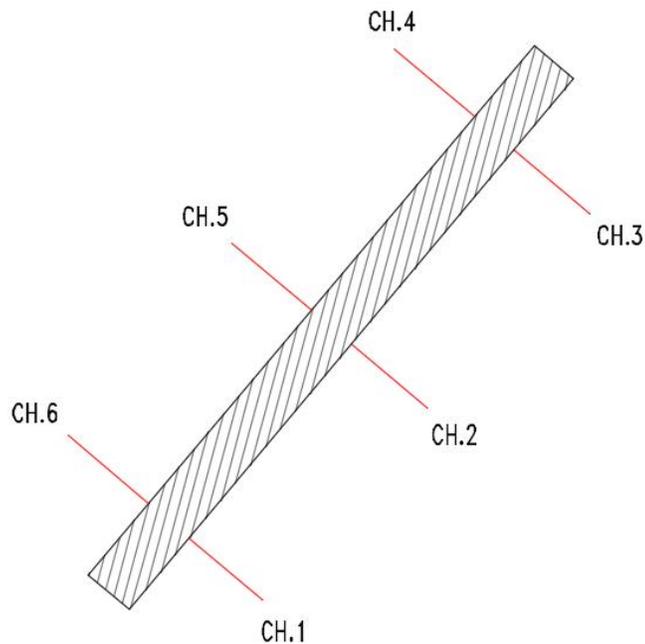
"Levantamiento en planta de chimeneas inclinadas; numeración de Chimeneas para Vertedero Industrial Dicham. Construcción propia"
